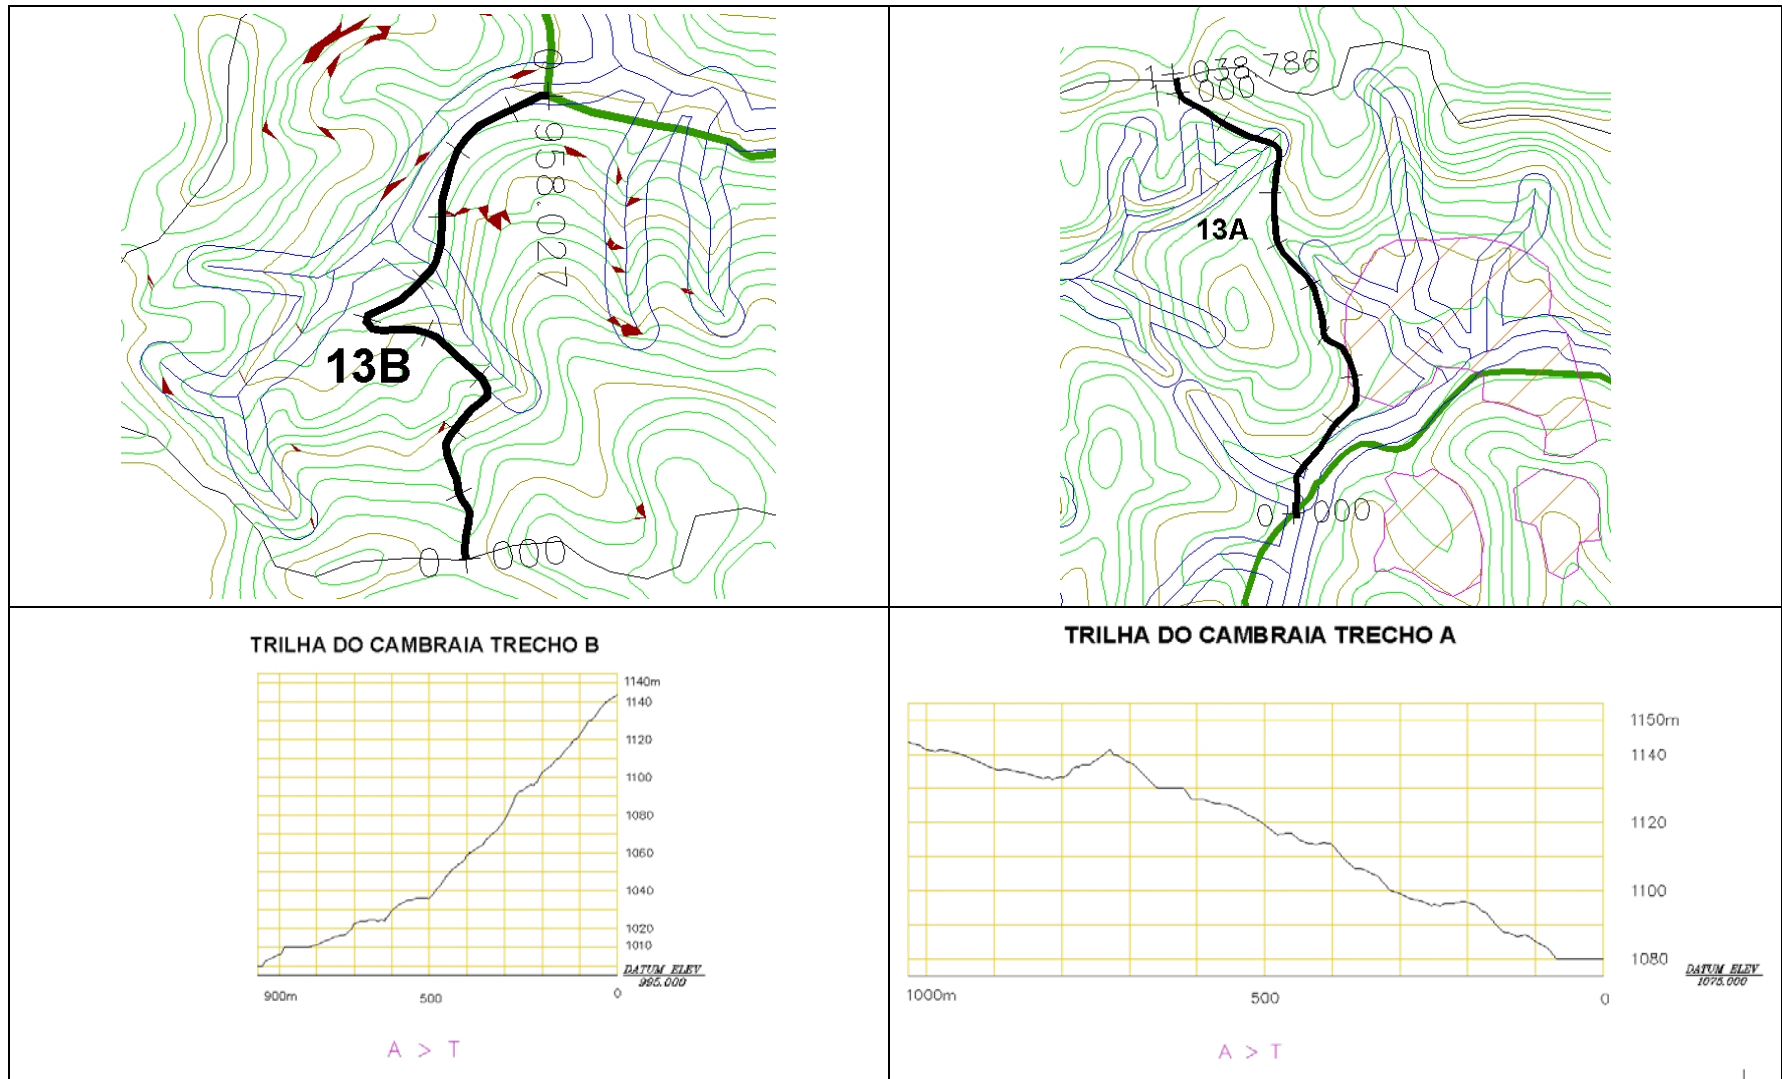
Planta e Perfil Topográfico da Trilha do Cambraia Trechos A e B – 13A (MB4) e 13B (MB1)
